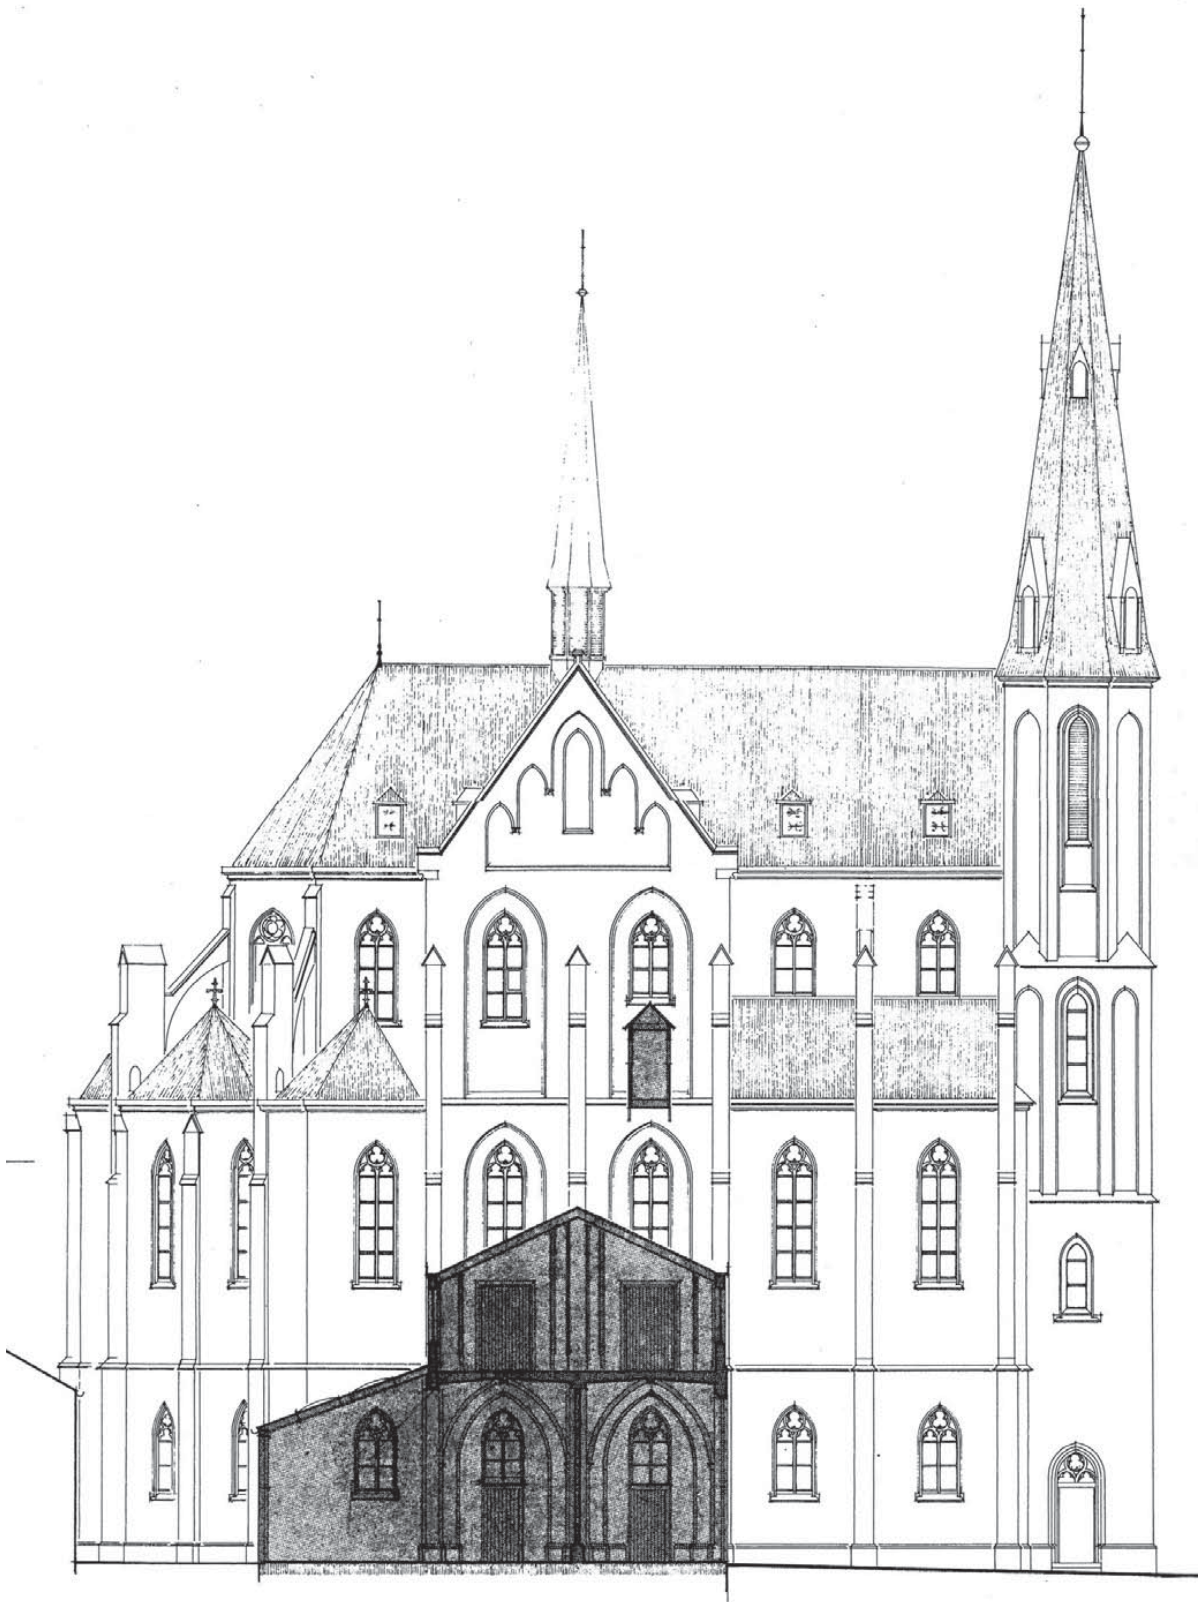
Aufriss Nordfassade, aufgenommen 1995 (Maßstab im Originalplan 1:100)
